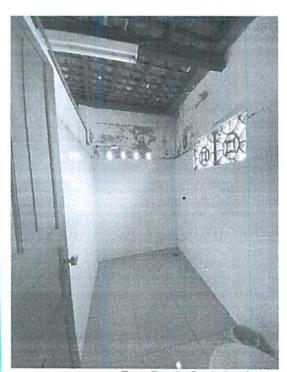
e 8: Cozinha/Copa com cobertura de telha cerâmica
